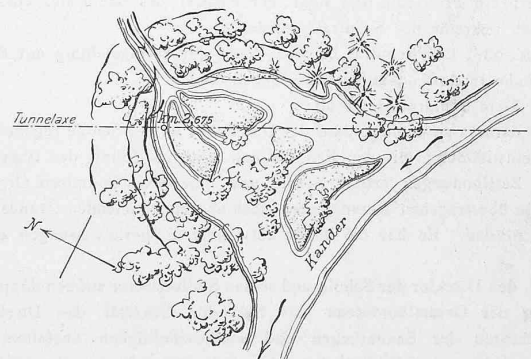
Lageplanskizze der Einsenkungsstelle. — Etwa 1:1500.
